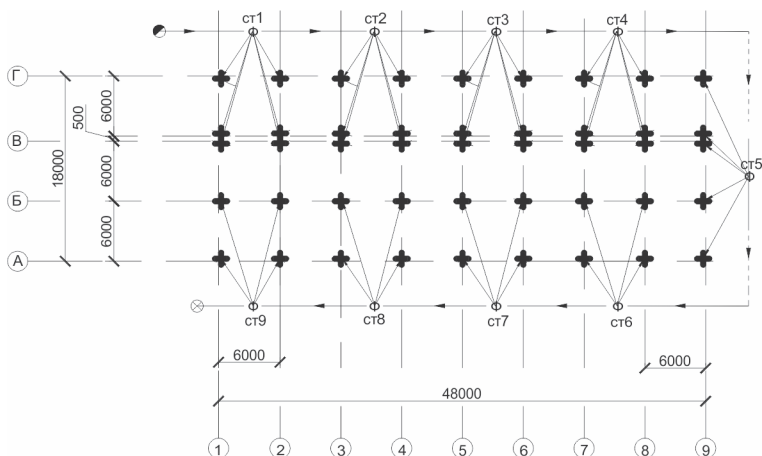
Схема проходки крана в процессе монтажа сборных фундаментов
